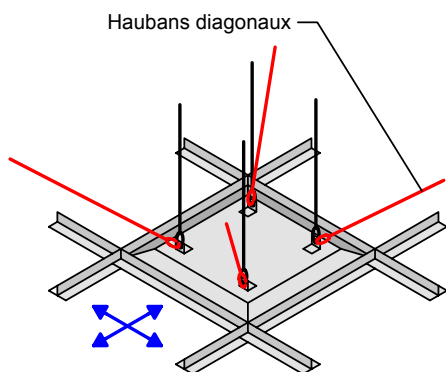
> Contreventement de luminaires sur un faux-plafond suspendu
